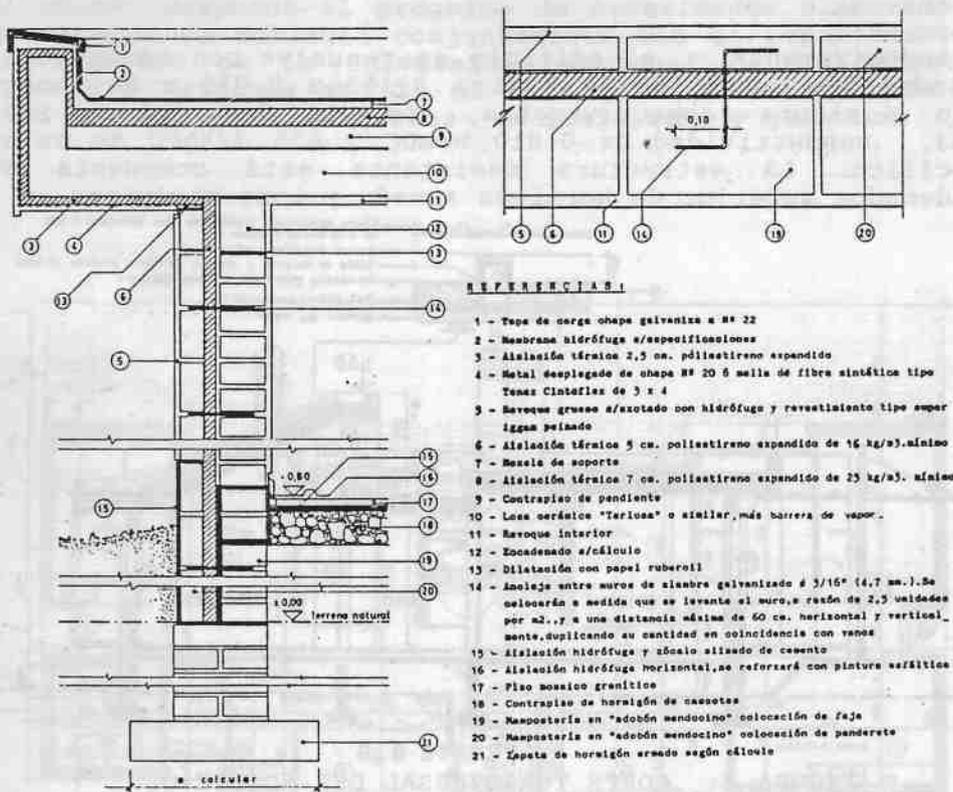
DETALLE CONSTRUCTIVO DEL PARAMENTO Y CUBIERTA DEL EDIFICIO.
